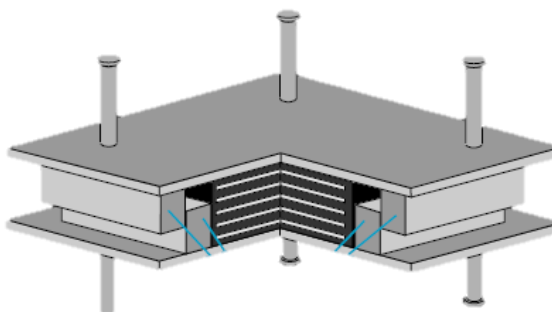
Aparelho de apoio de neoprene cintado fixo (fonte:(VSL))
